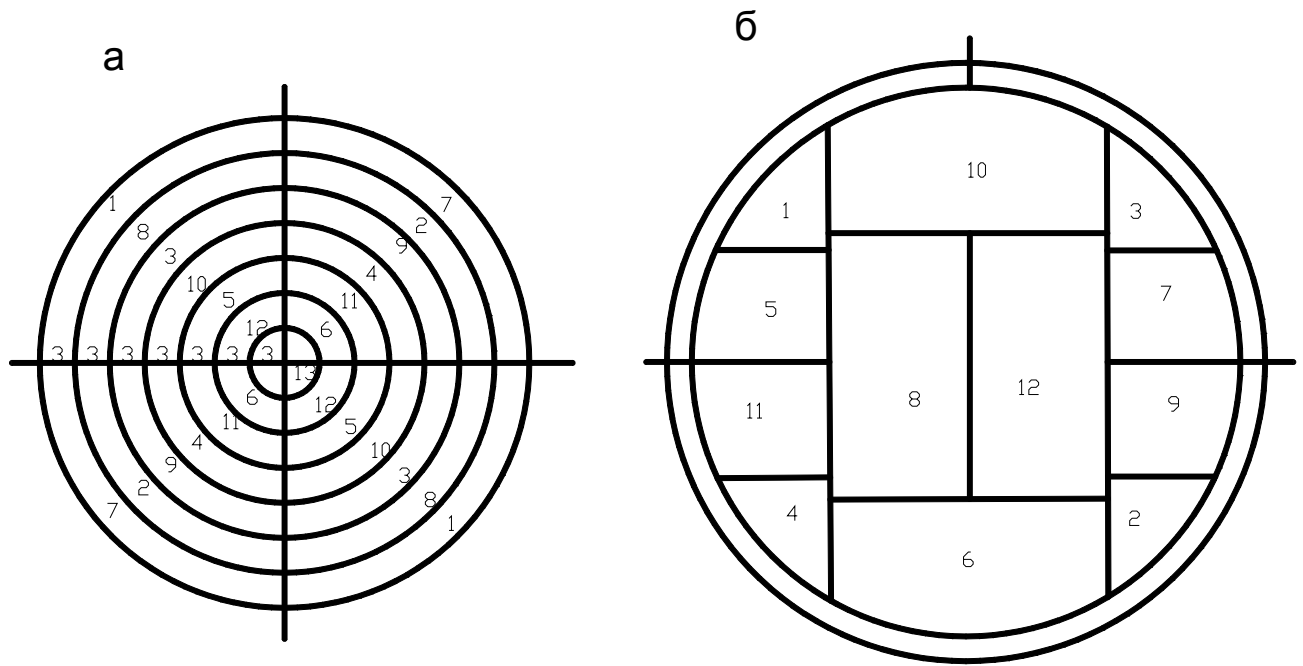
Послідовність укладки бетону у днище колодязя:
